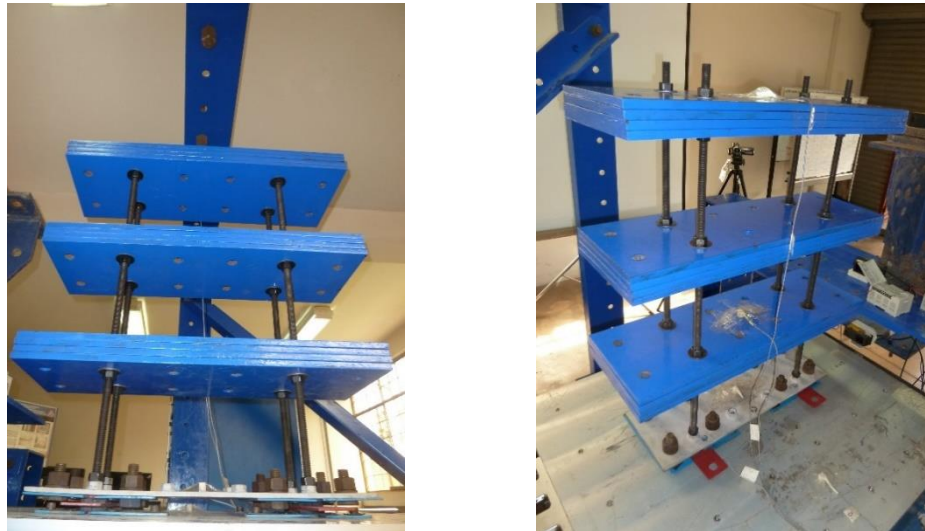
Espécimen de tres pisos a escala 1/10 con base aislada
